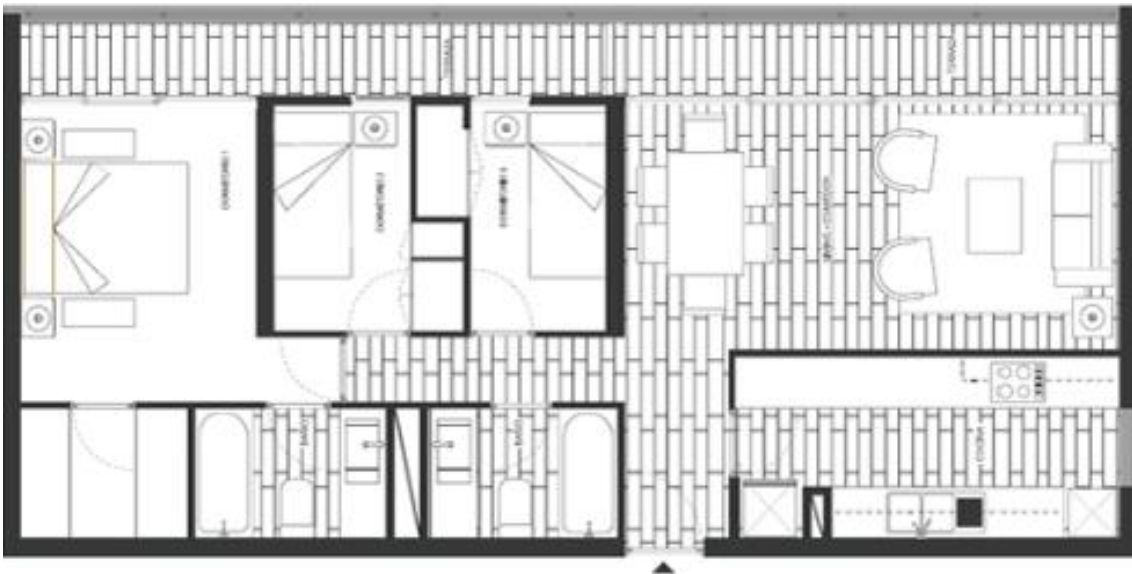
Planta departamento Tipo 6, proyecto Edificio Central (Fuente: <http://www.ilossilos.cl>)
